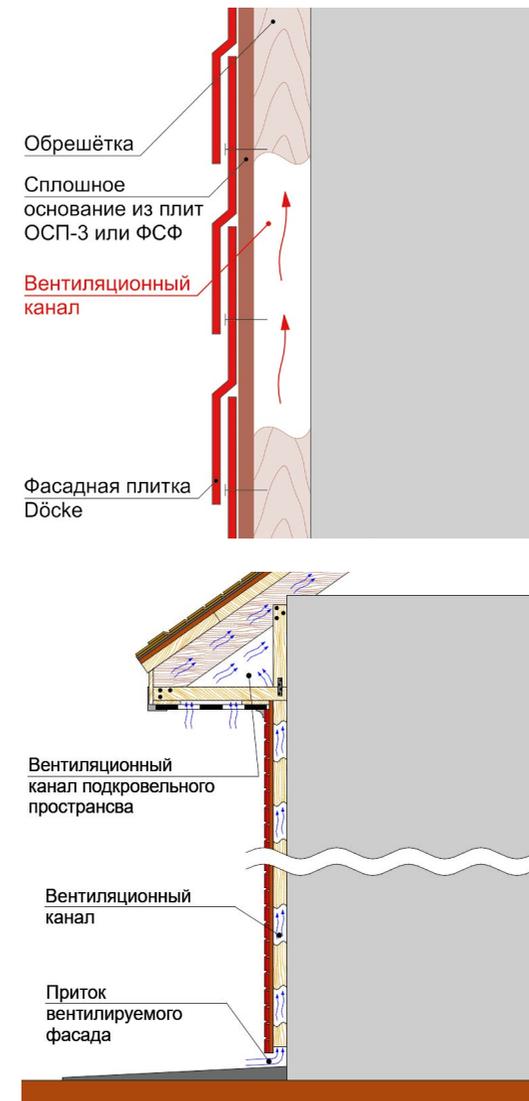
Схема вентилируемого фасада на примере фасадной плитки Döcke.
